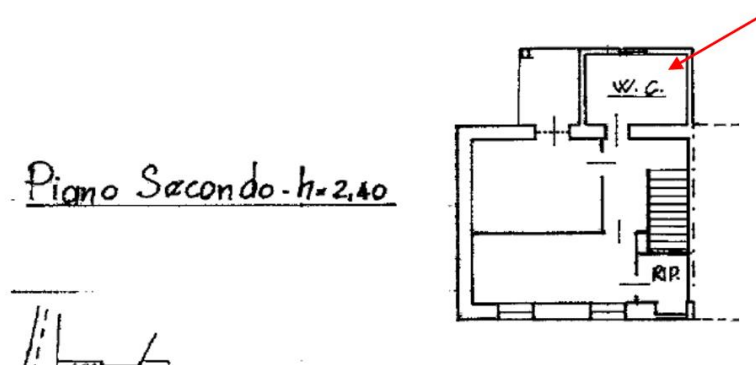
Estratto Planimetria catastale - pianta piano secondo
